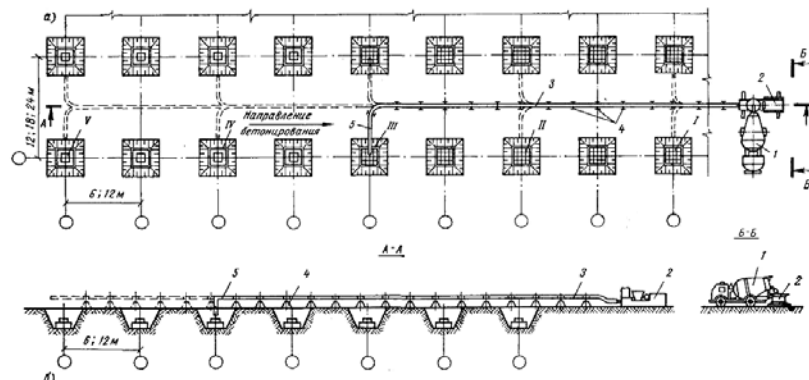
Схема технологического процесса устройства монолитных железобетонных фундаментов - бетононасосами
